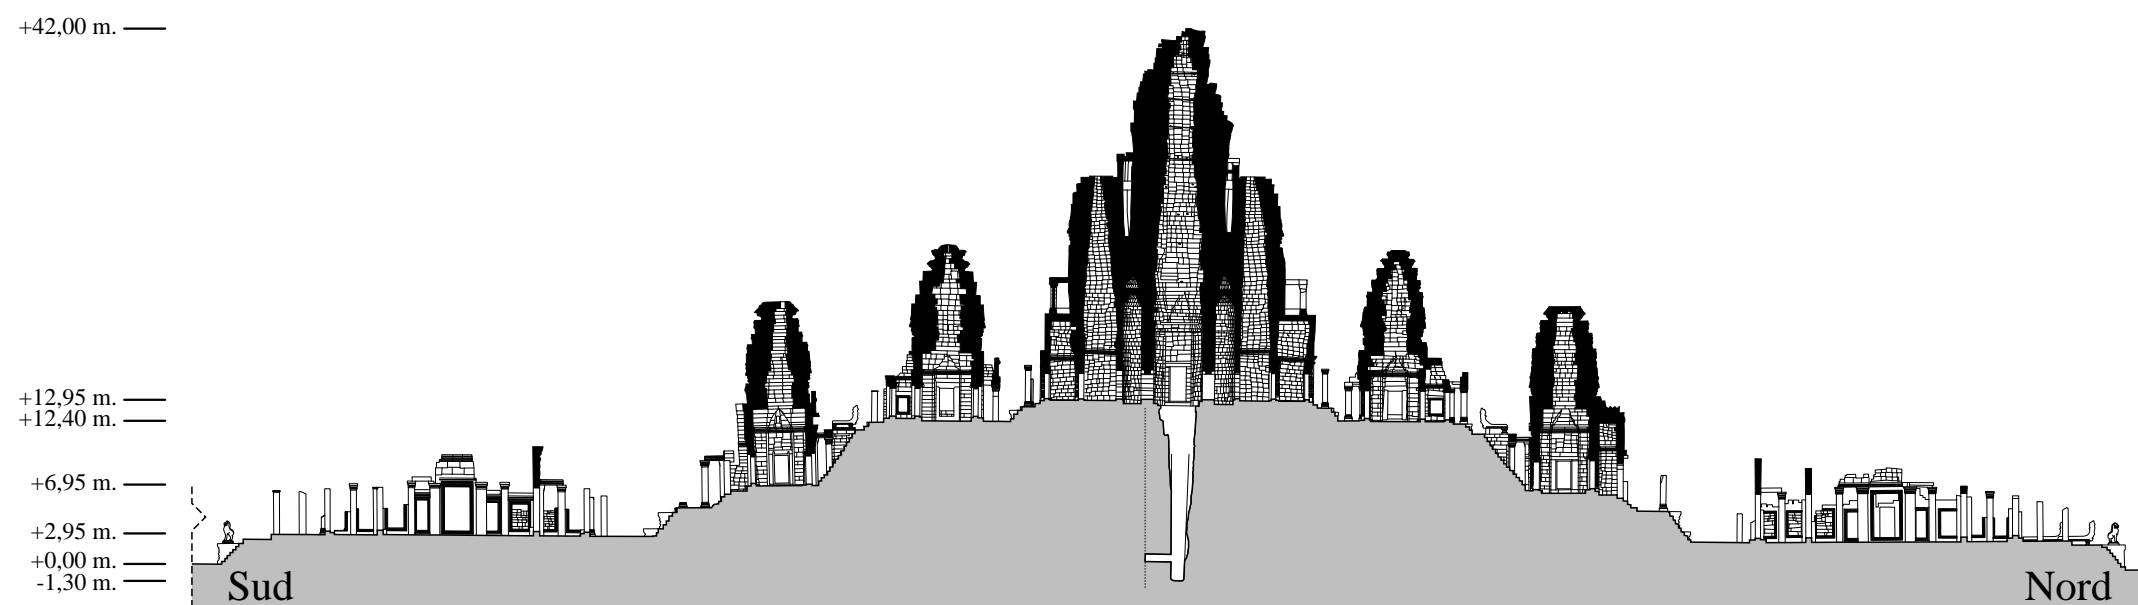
Coupe transversale du Bayon sur l'axe Nord-Sud vers l'Ouest
